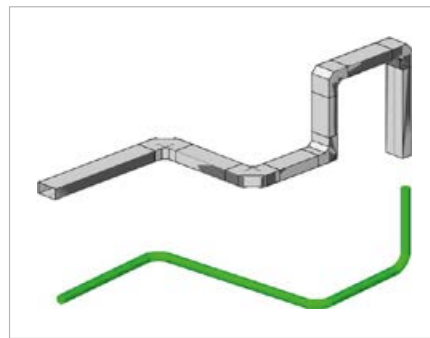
Прототип (прямоугольного и круглого сечений) + кабельная конструкция
